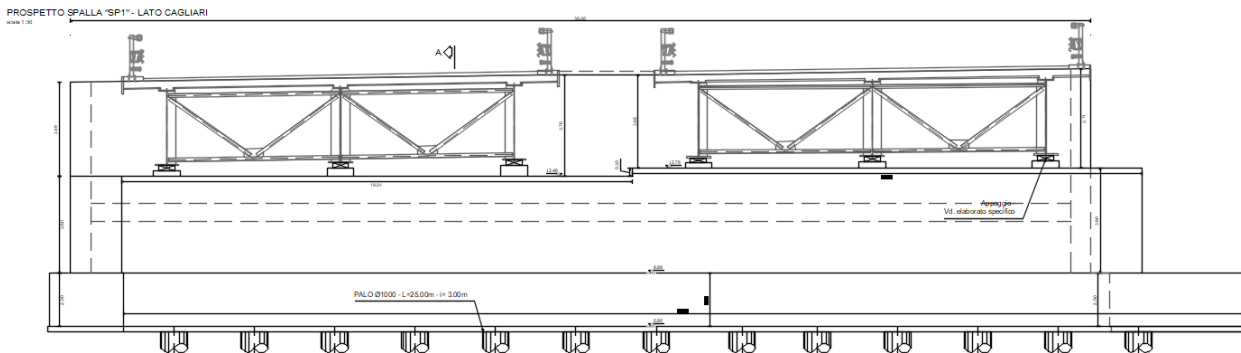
Prospetto spalla lato Cagliari
